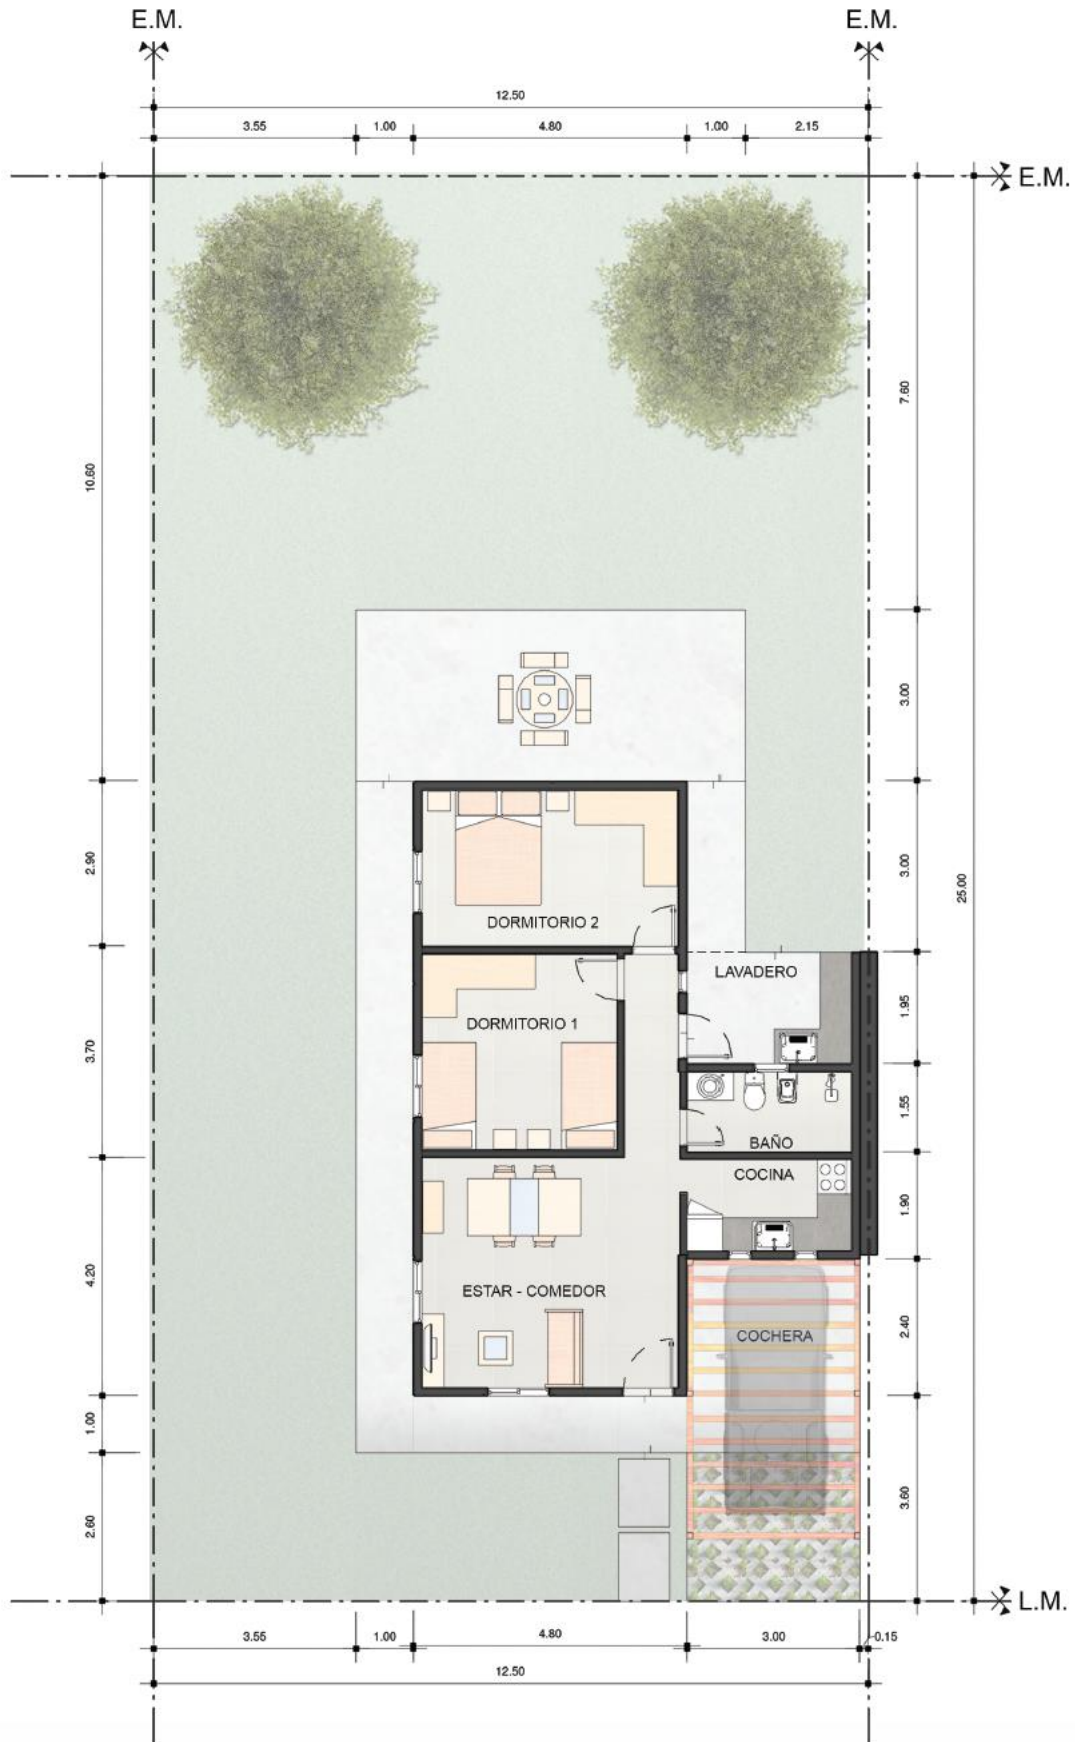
Planta vivienda tipo. (Fuente: Elaboración propia). Sin escala.
